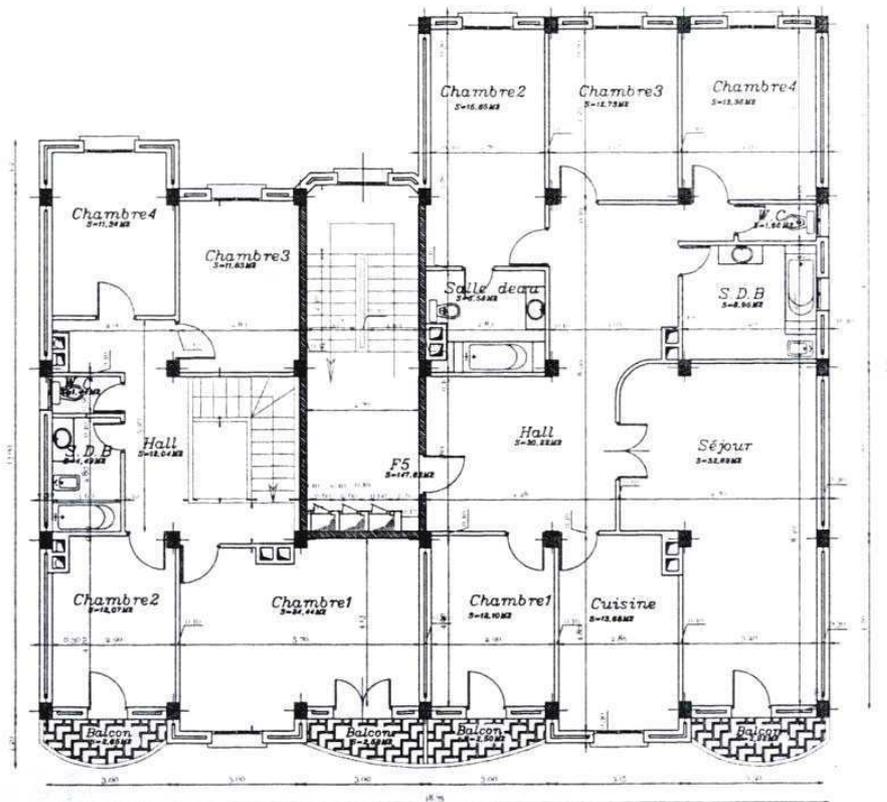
Plan du 5^{ème} étage d'un autre immeuble promotionnel
